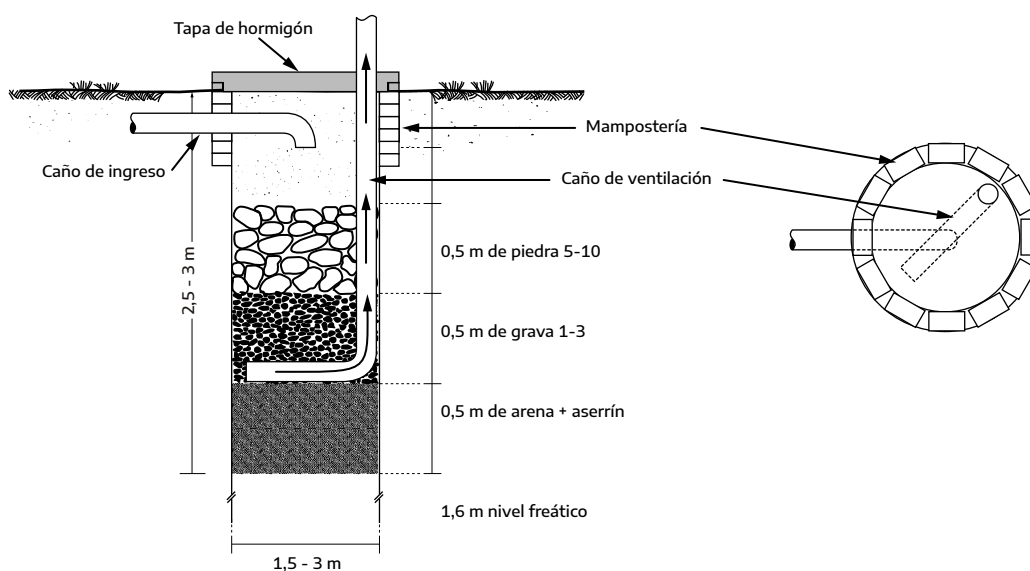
Pozo absorbente lleno de piedra. Corte y planta.
